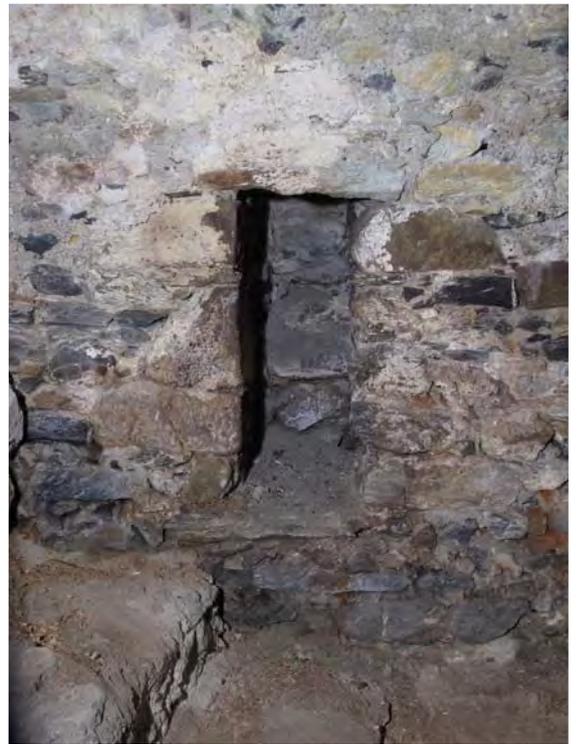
Sion, Platea. Cave P1d, paroi nord.
